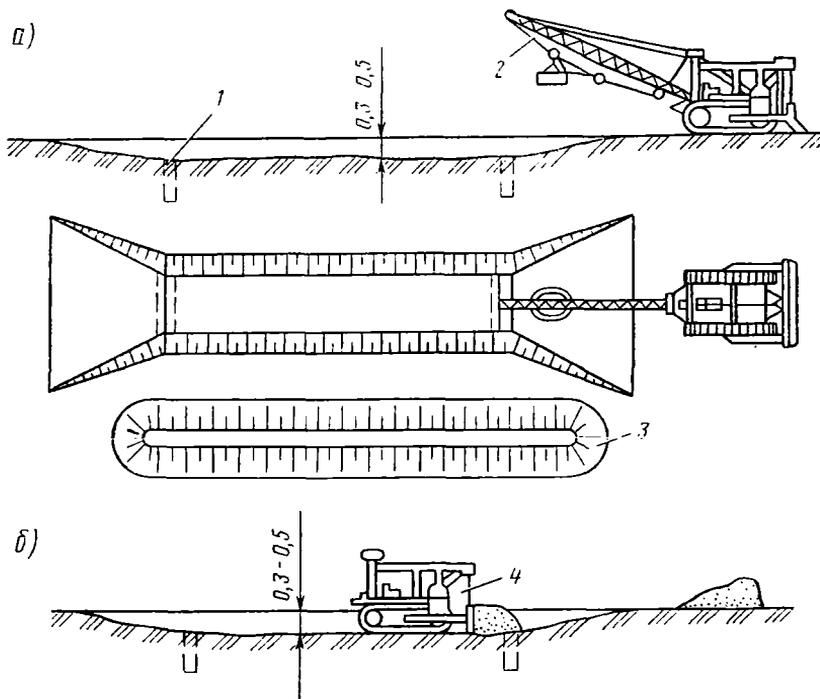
Схемы разработки котлована для фундамента трубы:
